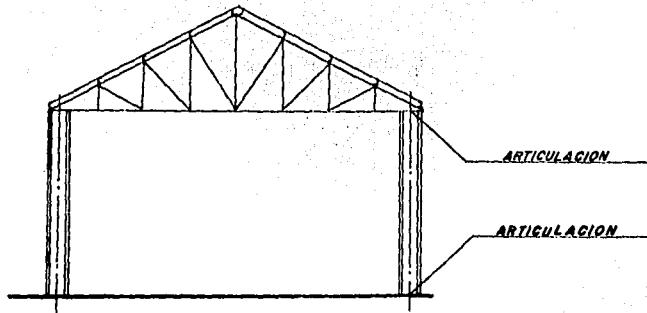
Estructuración típica de naves inestables ante cargas laterales, debido a las articulaciones en ambos extremos de las columnas
